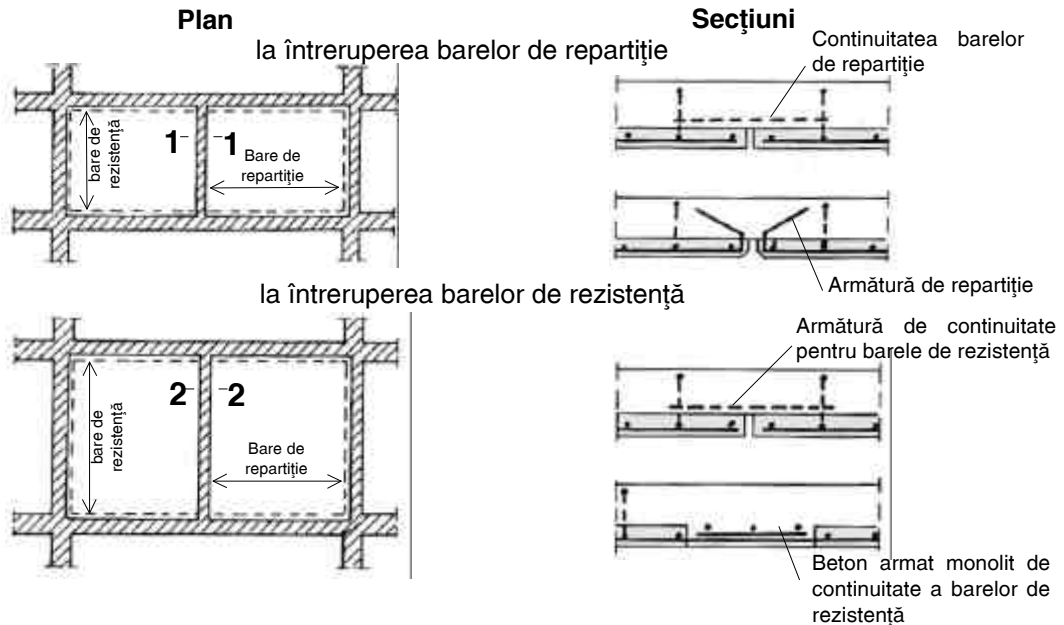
Planșee cu predală din beton armat. Tipuri de predale. Rezemare planșeu. Pozare predale. Plan. Secțiuni.
